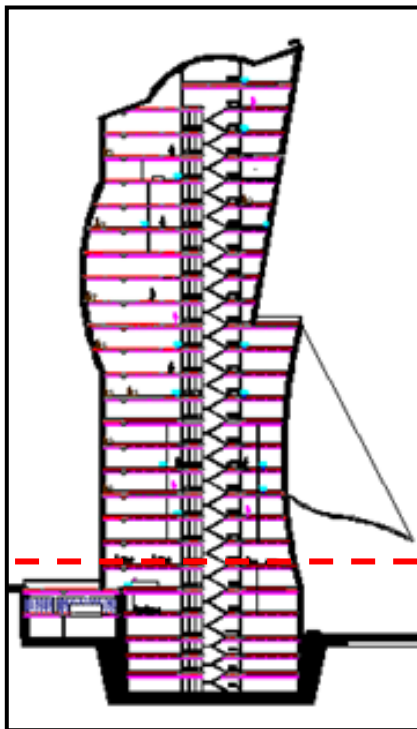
Coupe représentative des fondations de la tour Source : auteurs
